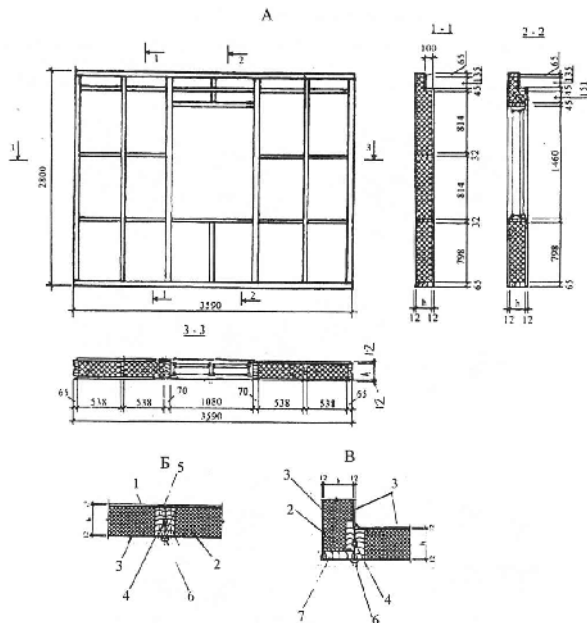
Наружные деревянные стеновые панели: А – схема панели; Б, В – стыки стеновых панелей: рядовой (Б) и угловой (В): 1 – гипсокартонный лист; 2 – утеплитель; 3 – цементно-стружечная плита; 4 – брусок; 5 – штапик; 6 – нащельник; 7 – обвязка каркаса
